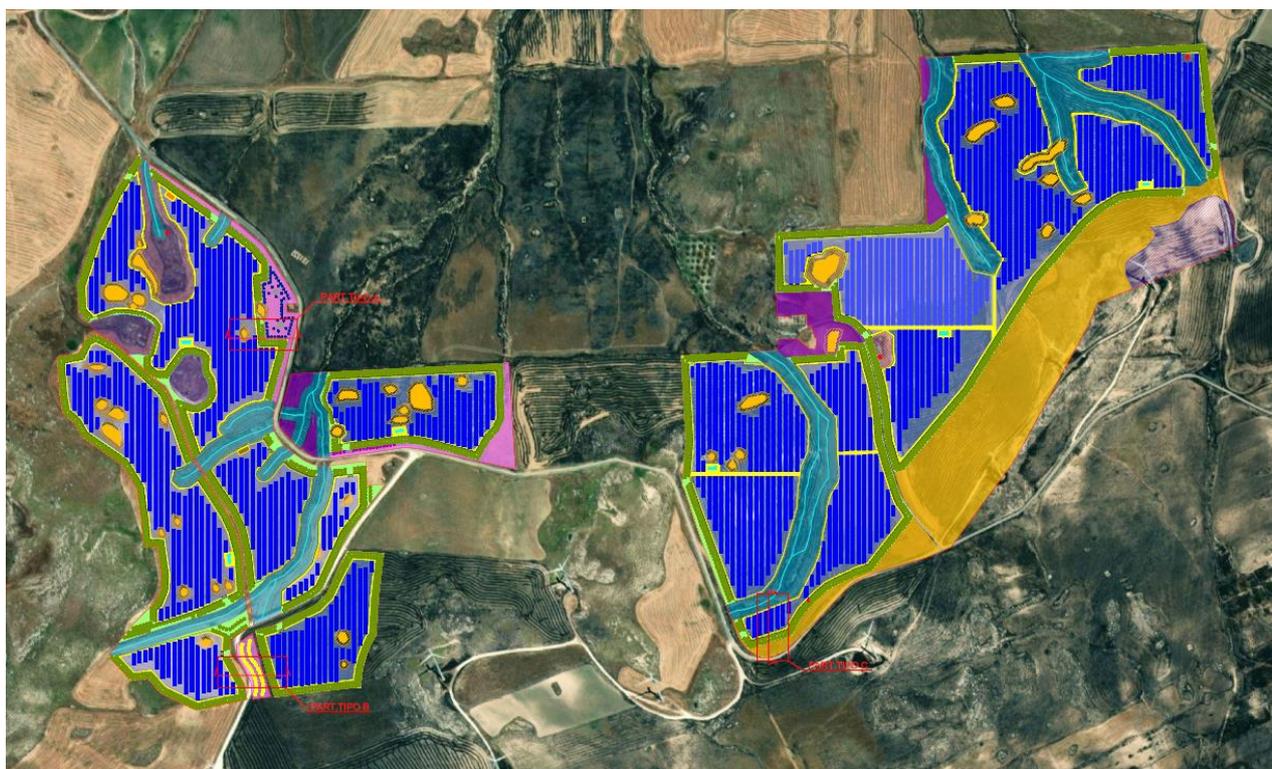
PLANIMETRIA SISTEMAZIONE A VERDE OPERE DI MITIGAZIONE (ESTRATTO DA MINEO-PDT11)
